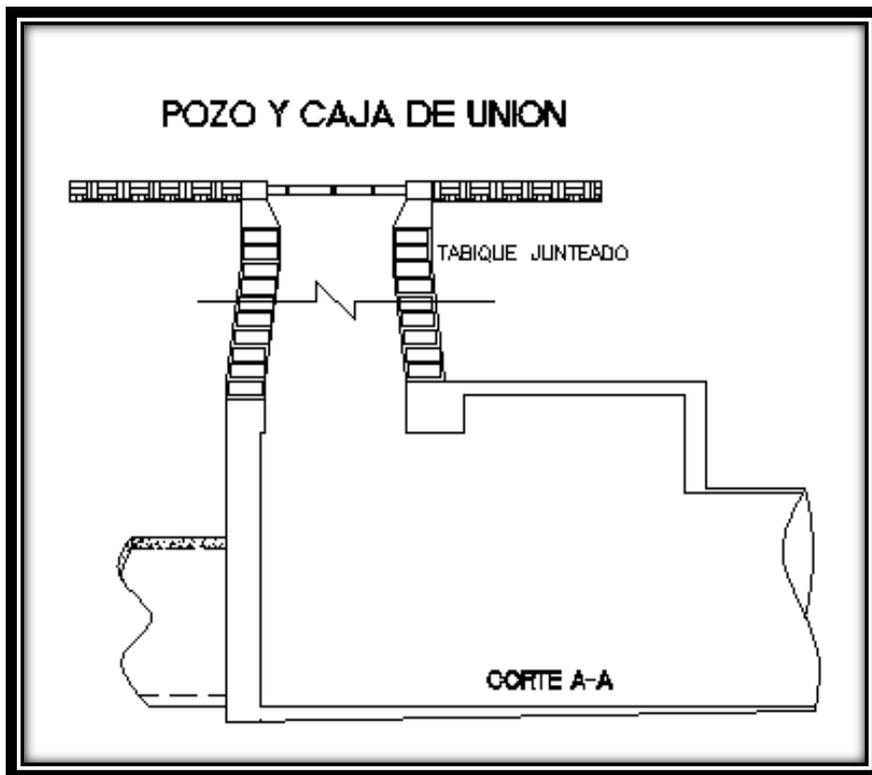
Estructura de pozo y caja de unión, (Ref. 1)
